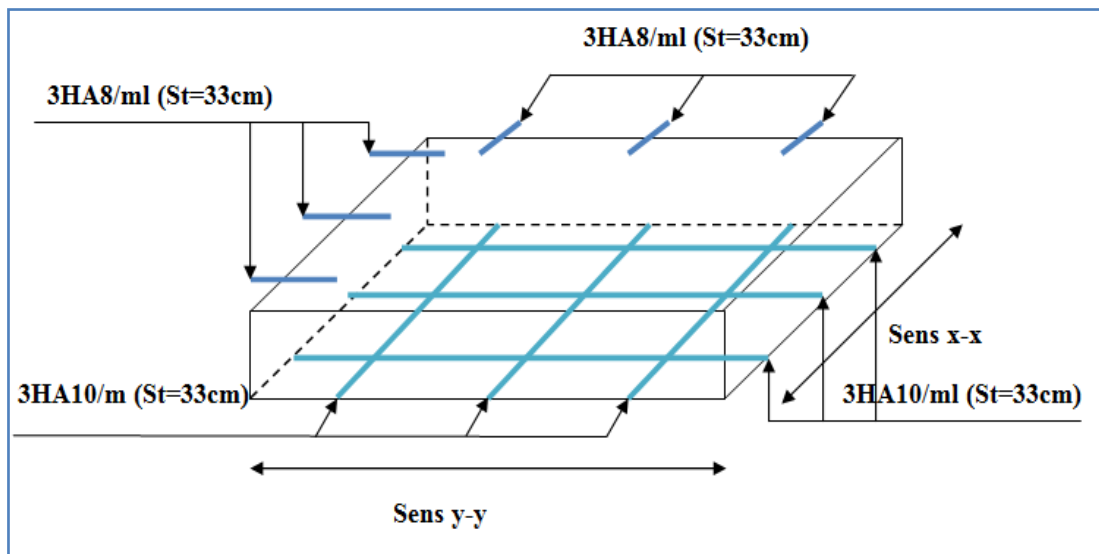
Schéma de Ferrailage de la dalle pleine du local machinerie
